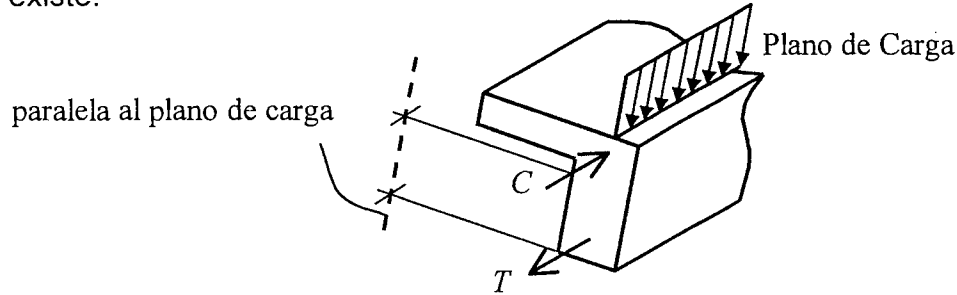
Viga aislada con sección transversal asimétrica con respecto al plano de carga.
